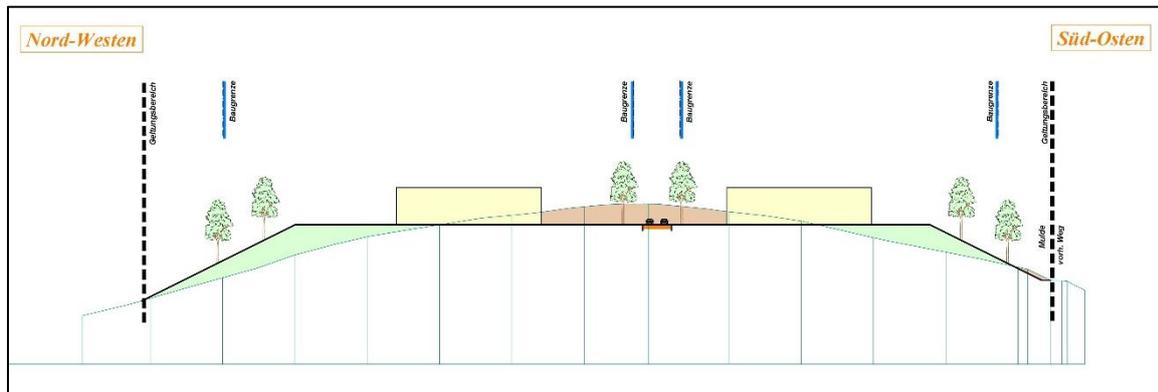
Schemaschnitt Terrassierung (Finger Bauplan GmbH)
